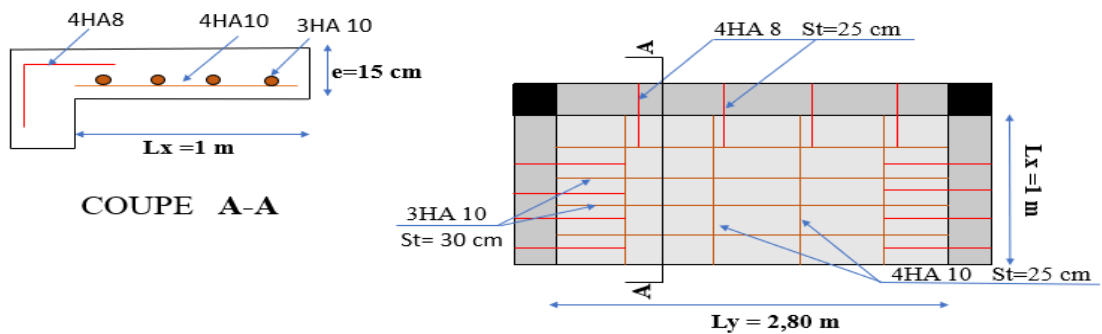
Schéma ferrailage sur trois appuis (DP4)
